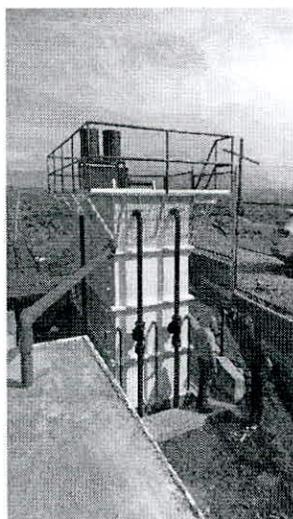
estado de la fuente y tubería de conducción encofrad en concreto
